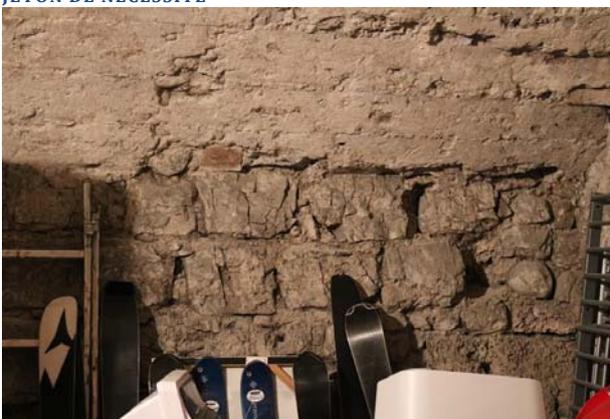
PARCELLE 24 – MUR DU FOND DE LA CAVE
